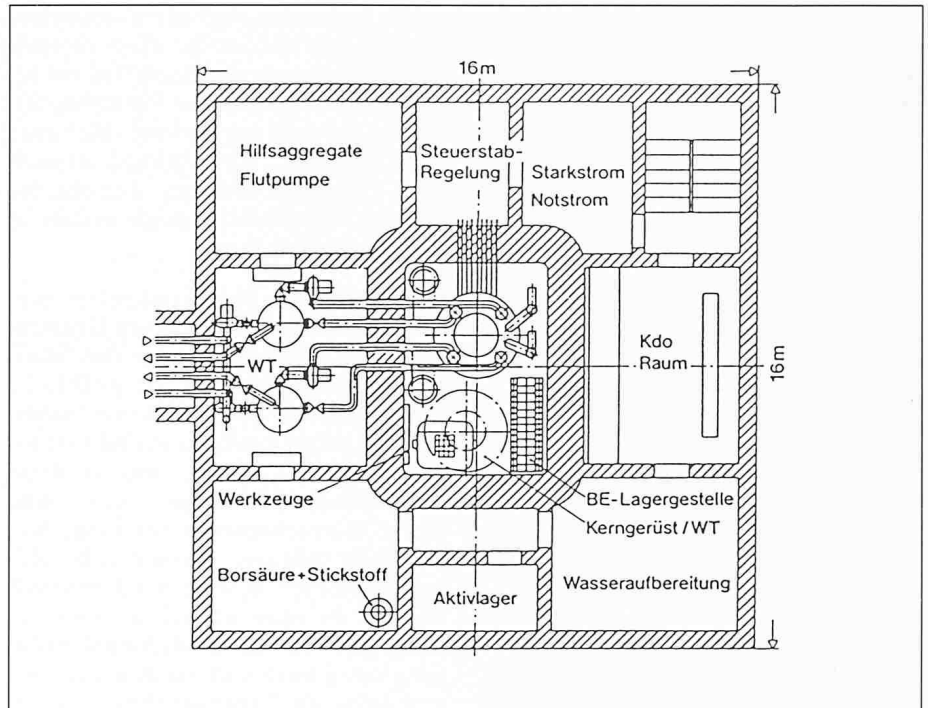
SHR-Heizreaktor, Grundriss
